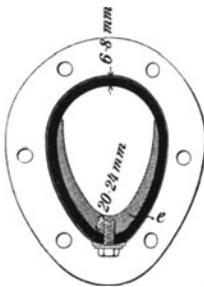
Spülrohr mit eiförmigem Querschnitt und Walzeisenlage.
